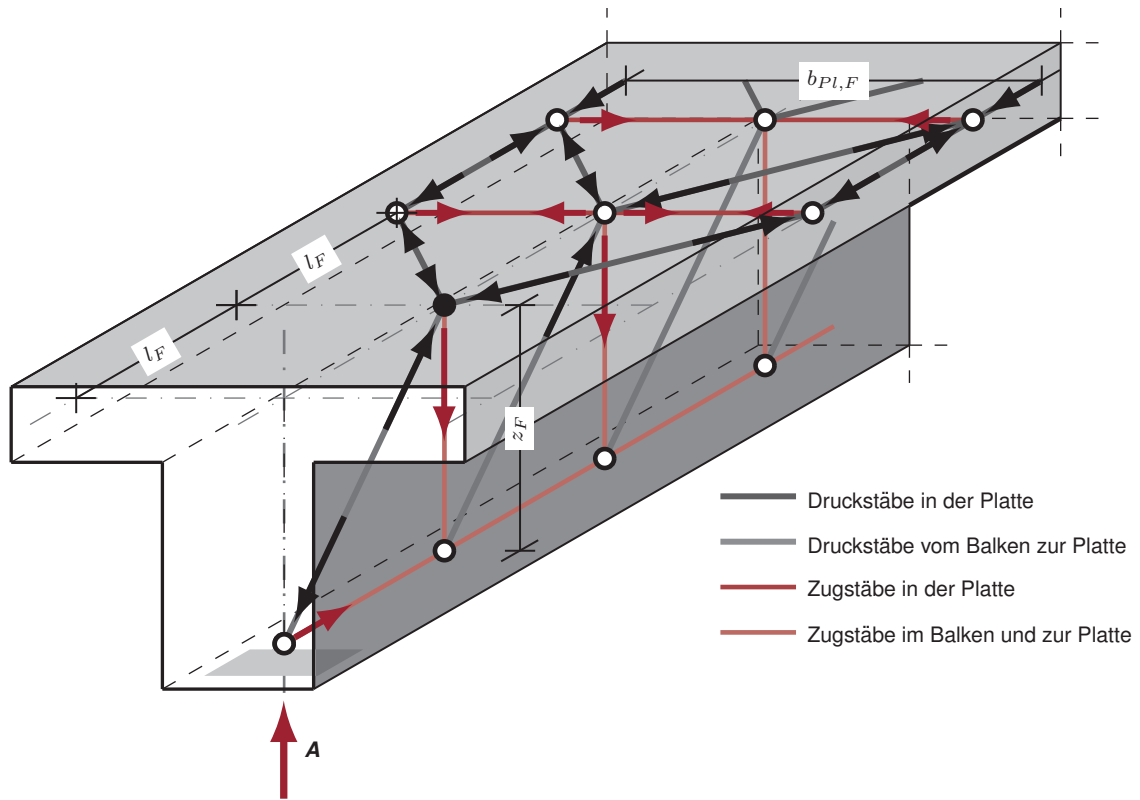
Räumliches Stabwerkmodell zur Einleitung einer Auflagerkraft in einen Plattenbalken
